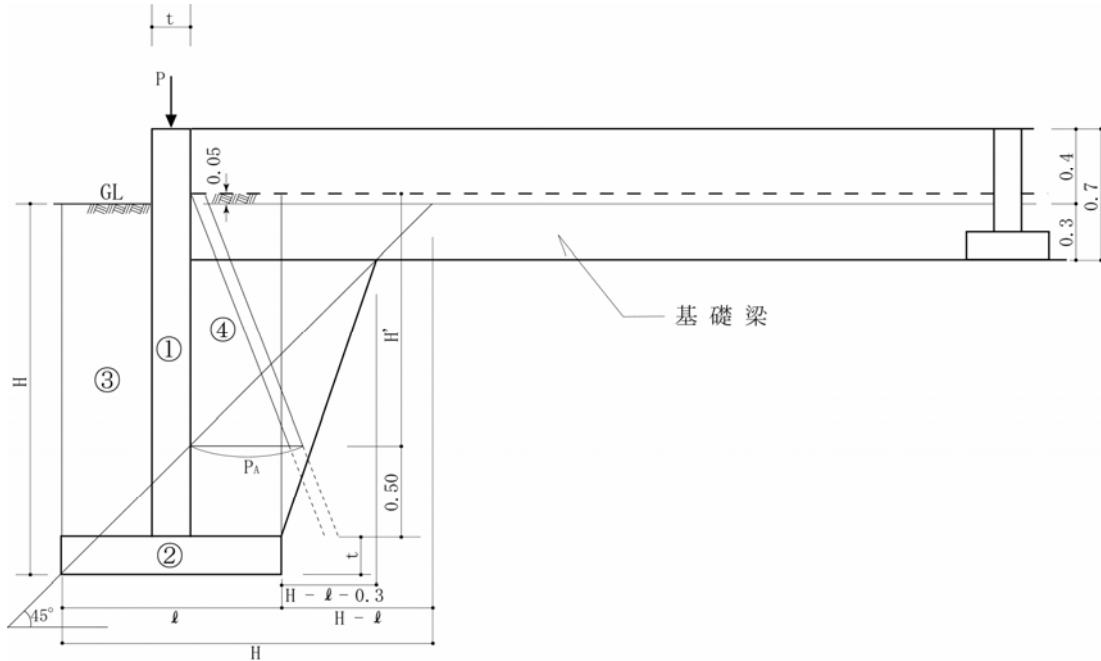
1 布基礎 - 直接基礎による立ち下げ (断面図)
